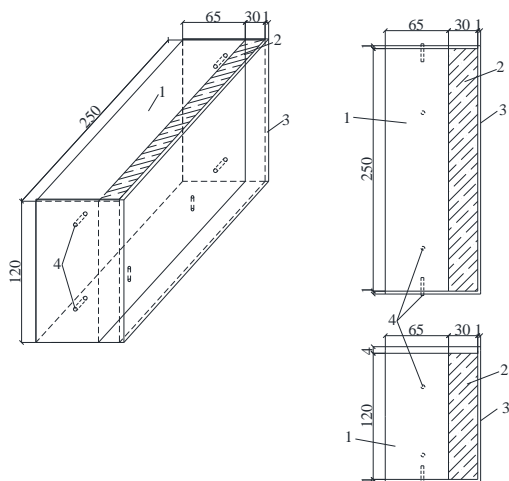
Схема опалубки для формування штукатурного шару на цеглі. 1 – цегла; 2 – штукатурний шар; 3 – опалубка; 4 – фіксатор
